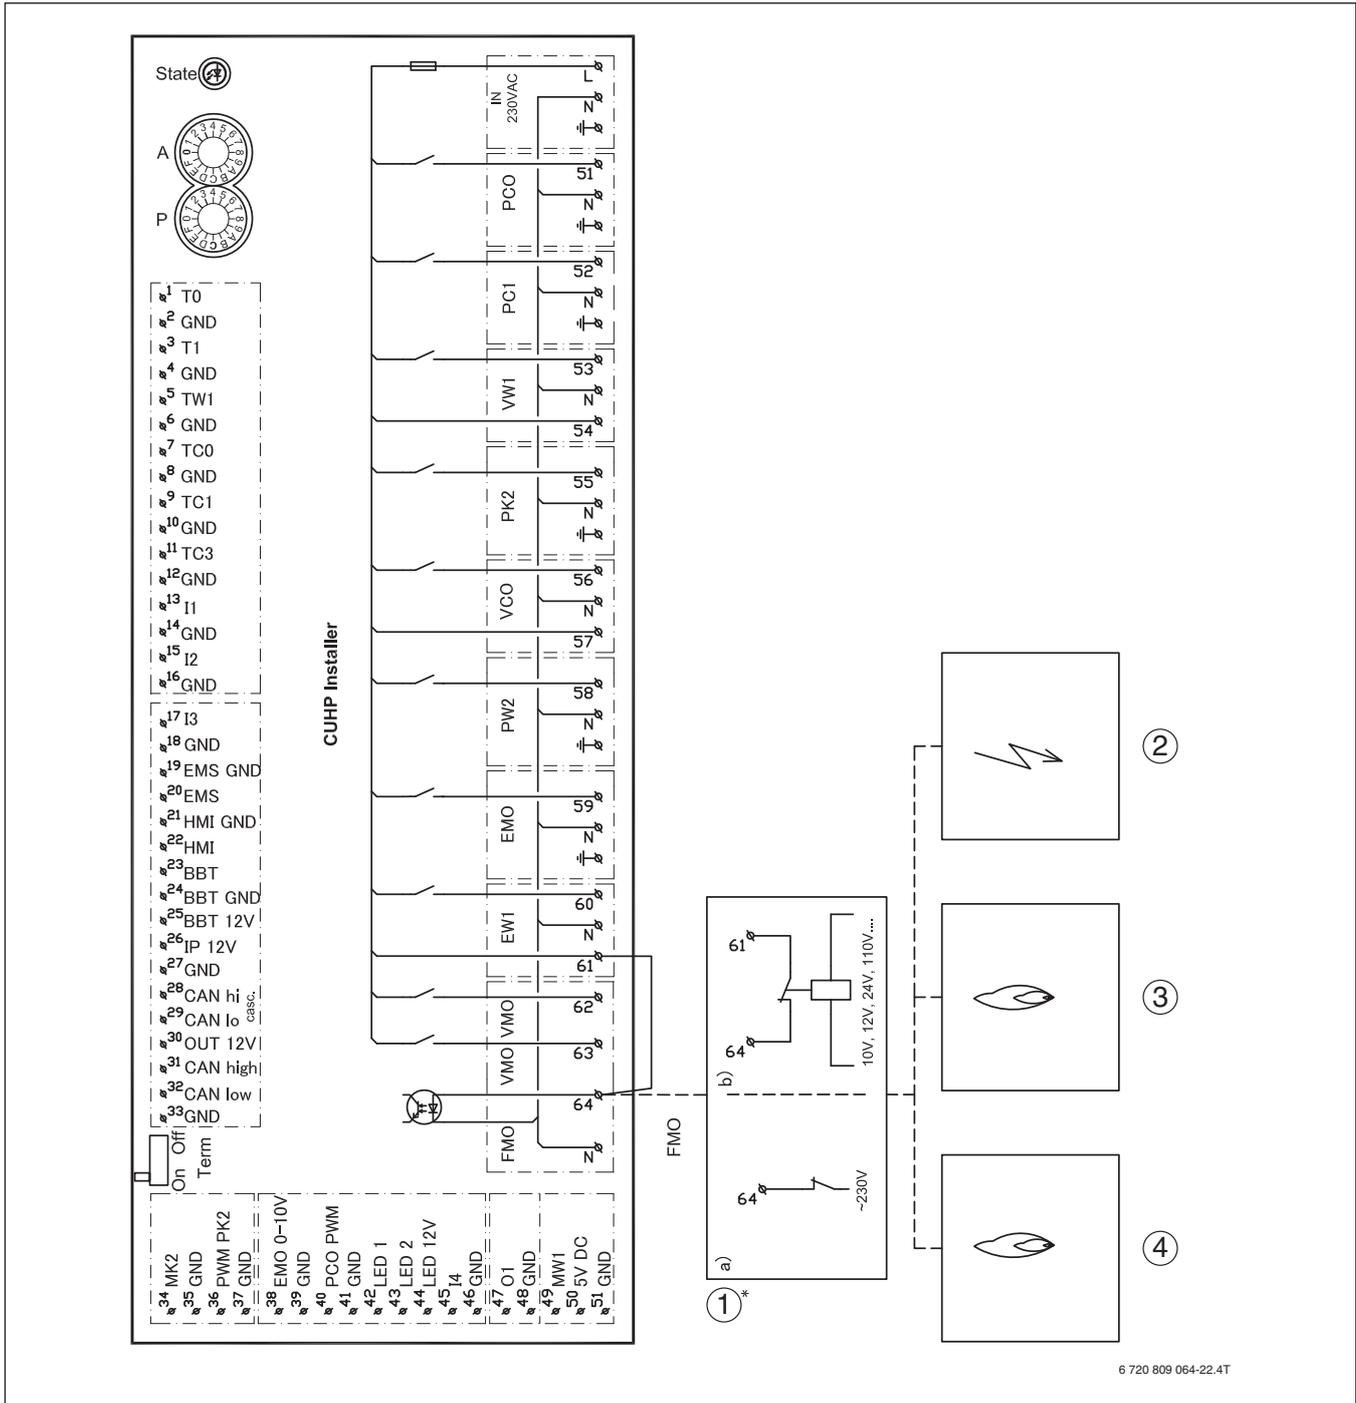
Schaltplan Installationsmodul, Alarm des externen Zuheizers
